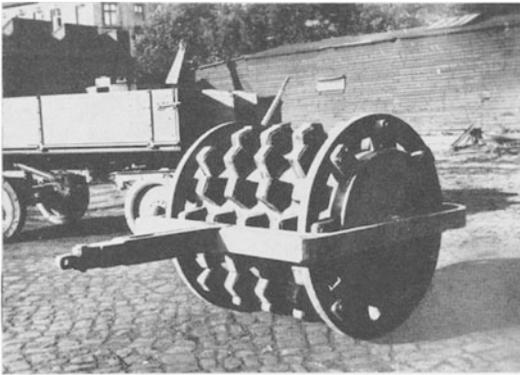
Schaffußwalzen (Walze mit Druck-Knetwirkung)
